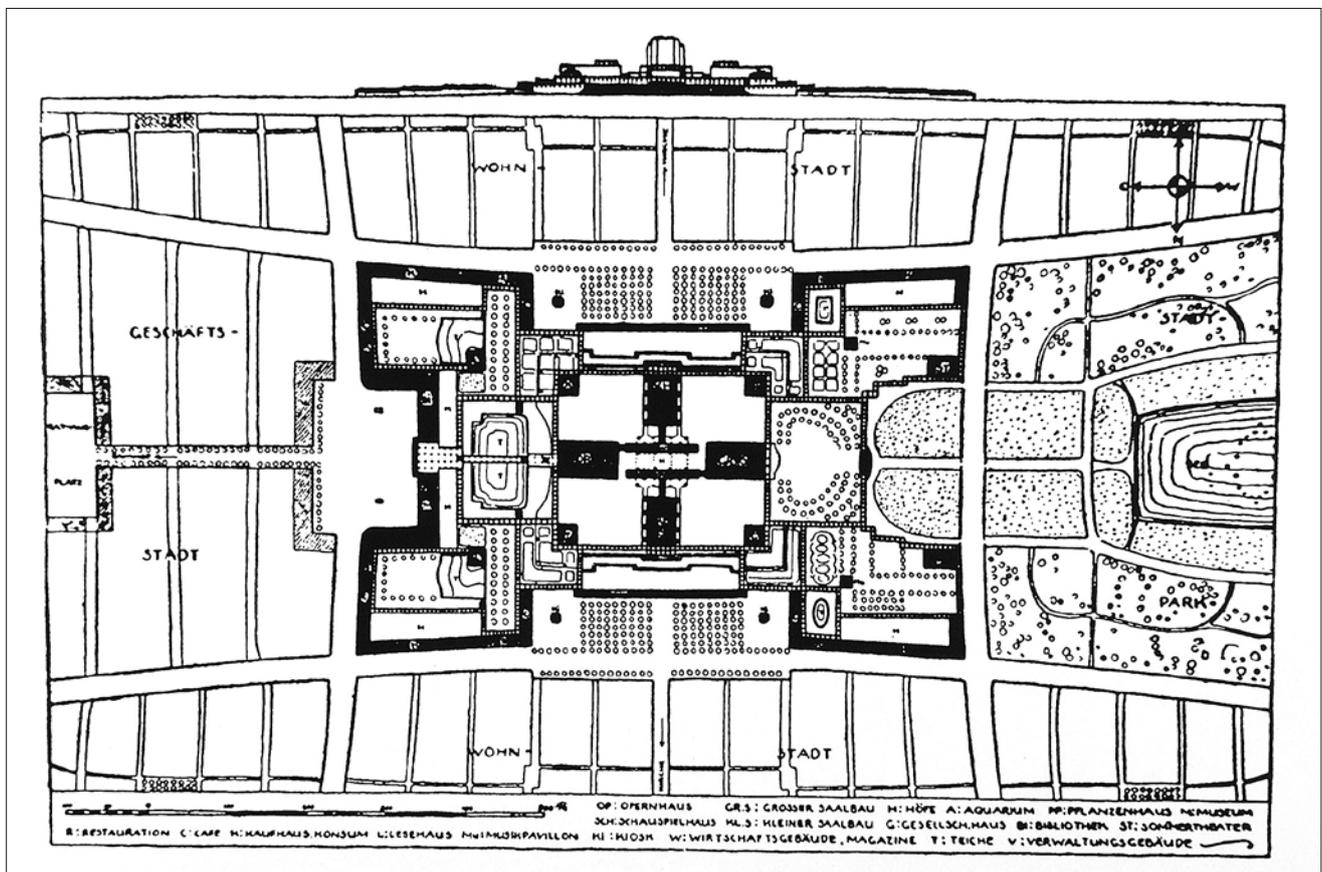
Bruno Taut, Plan und Silhouette der Stadtkrone, 1919
